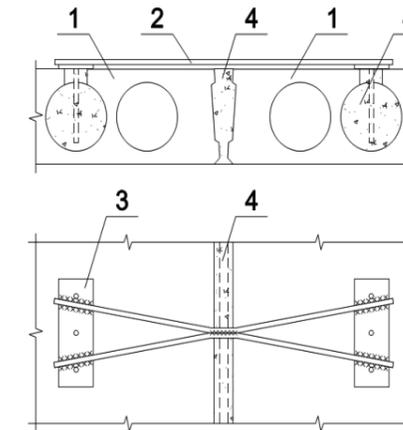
Связи сдвига между многопустотными плитами перекрытий безопалубочного формования. 1-плита перекрытия, 2- связи из арматурной стали класса А240, 3- закладные детали в плите перекрытий (могут устанавливаются после монтажа перекрытия или на заводе-изготовителе), 4- бетон замоноличивания стыка.
